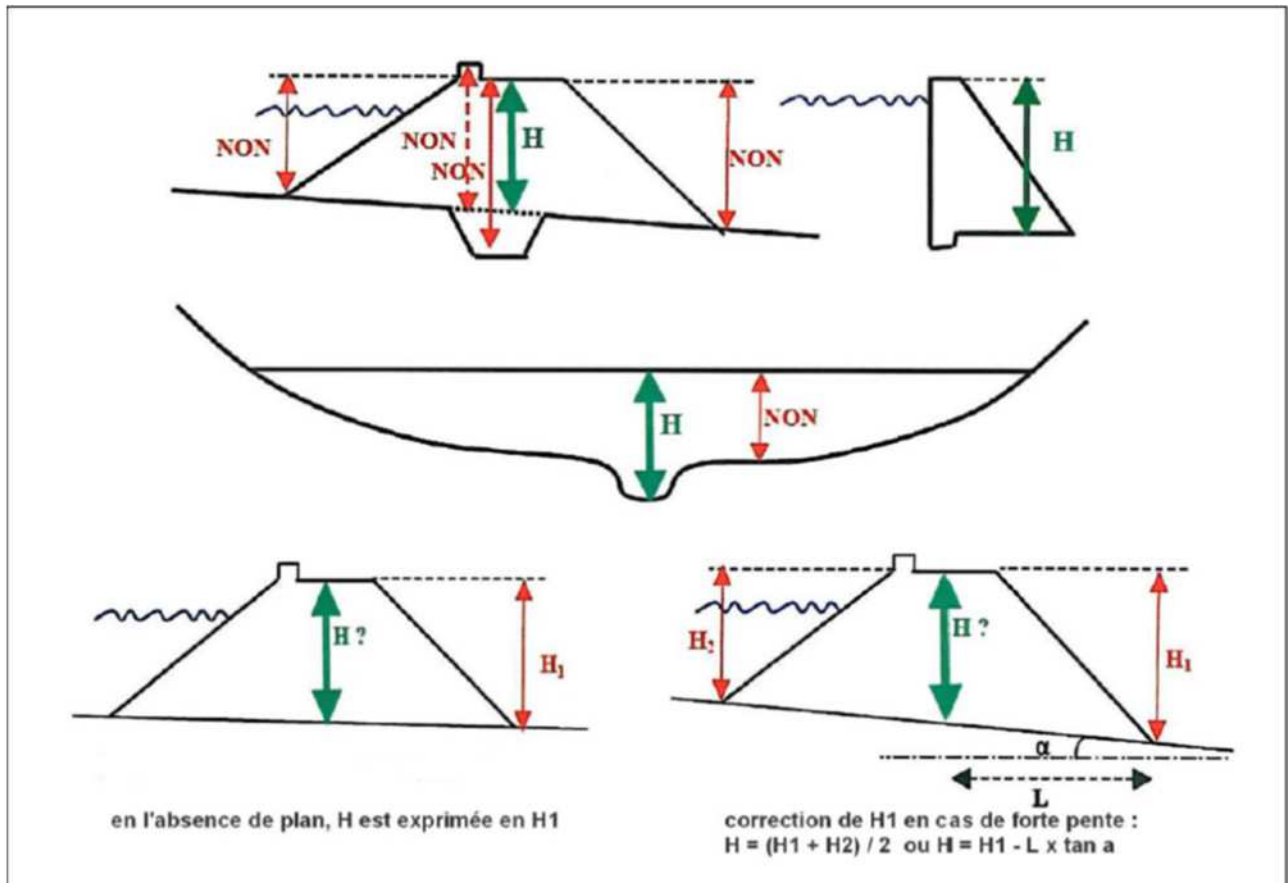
Coupes schématique d'un barrage en terre ou d'un barrage poids
